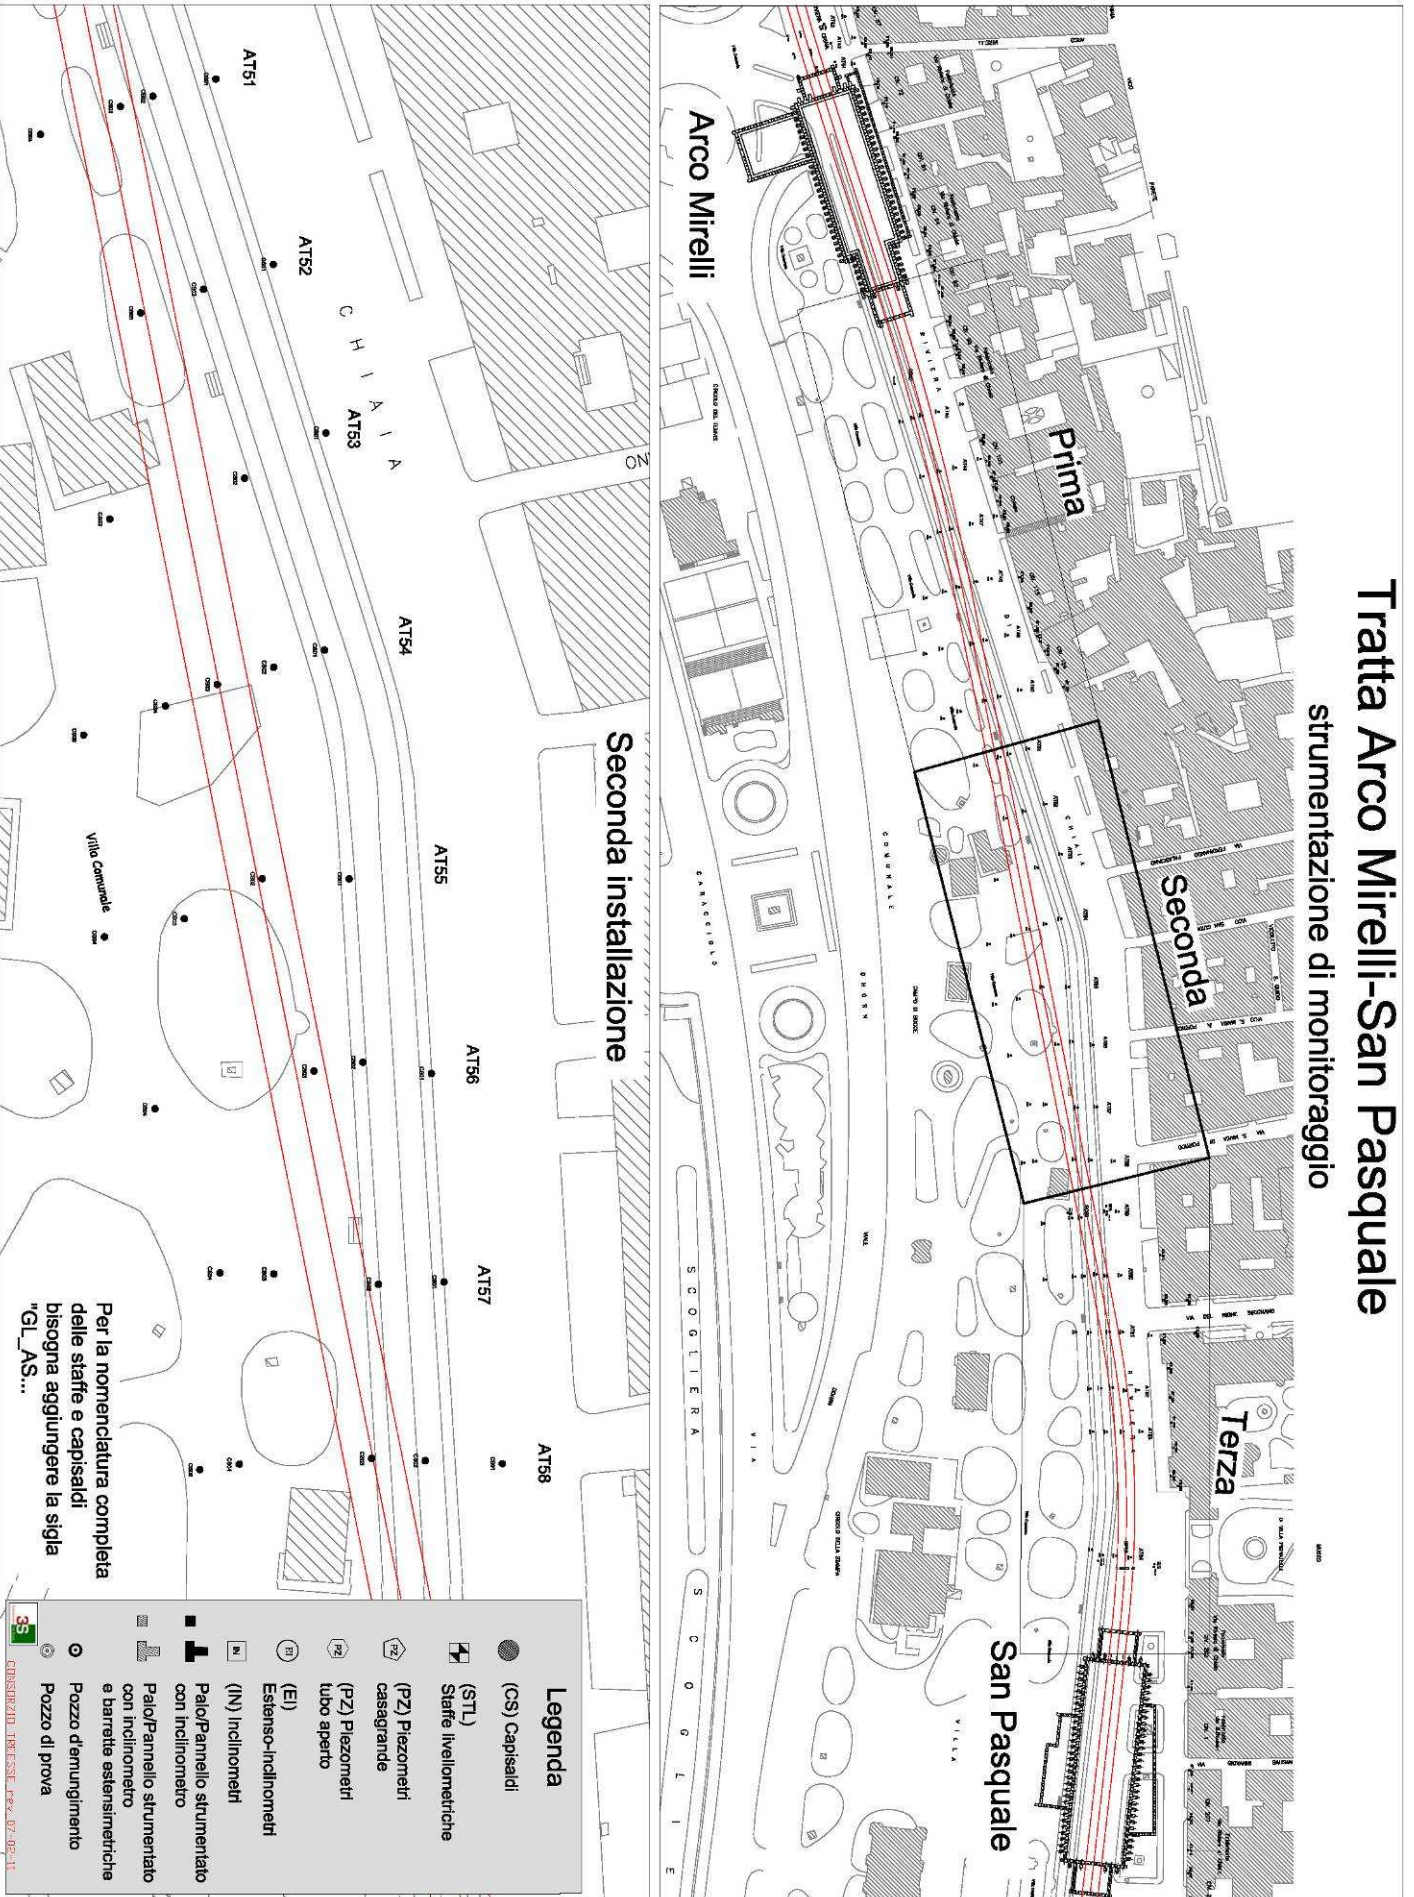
Planimetria tratta Arco Mirelli-SanPasquale, raffigurante la disposizione della seconda installazione della strumentazione di monitoraggio.
